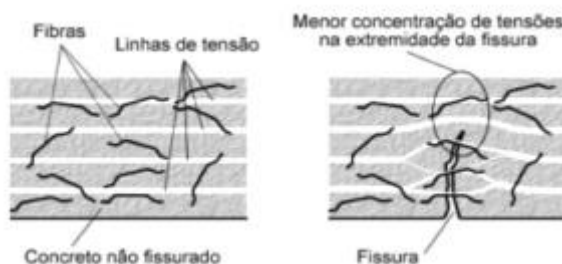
Propagação de fissuras em concreto reforçado com fibras (Fonte: Barros, 2009, apud Do Nascimento, 2015).
